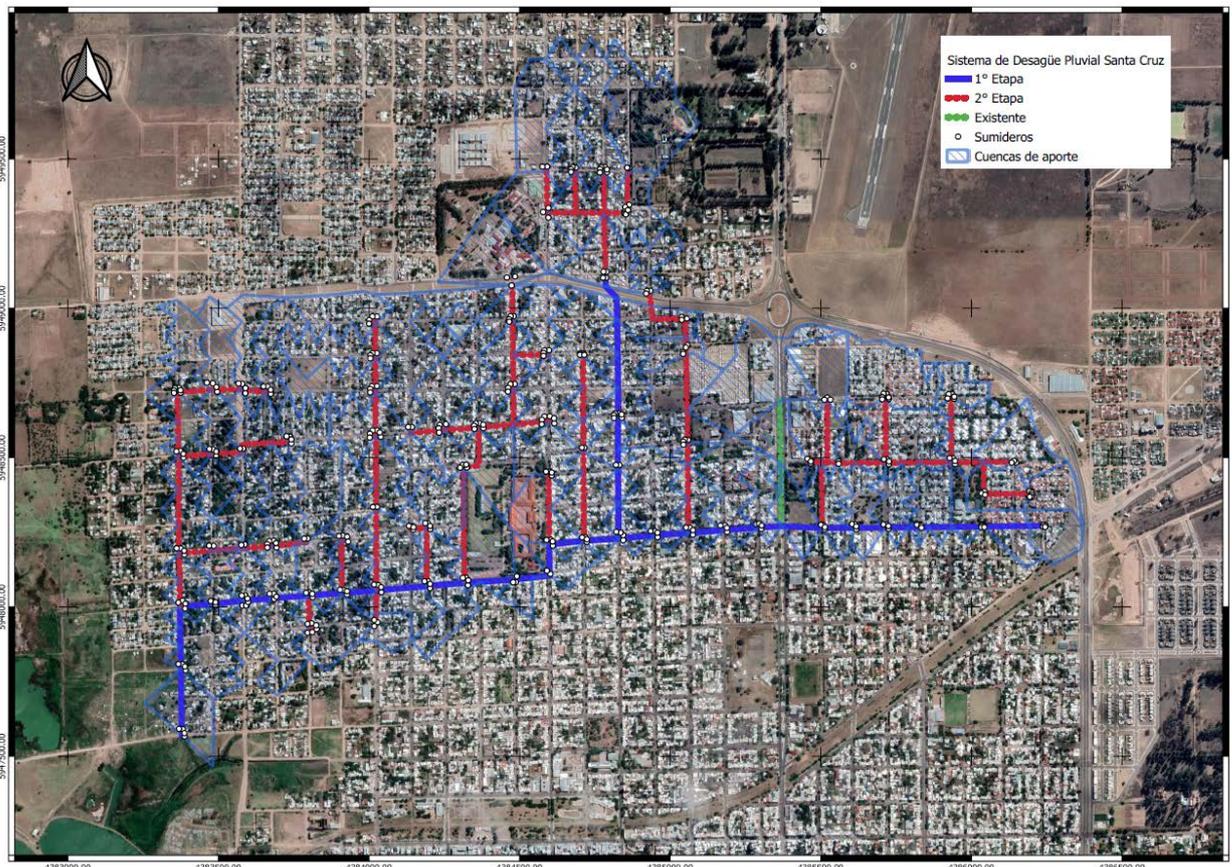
Sistema de Desagüe Pluvial Santa Cruz
